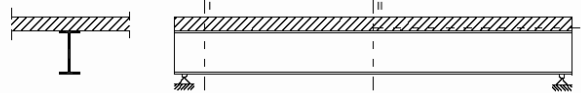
Trave d'acciaio con soletta collaborante
